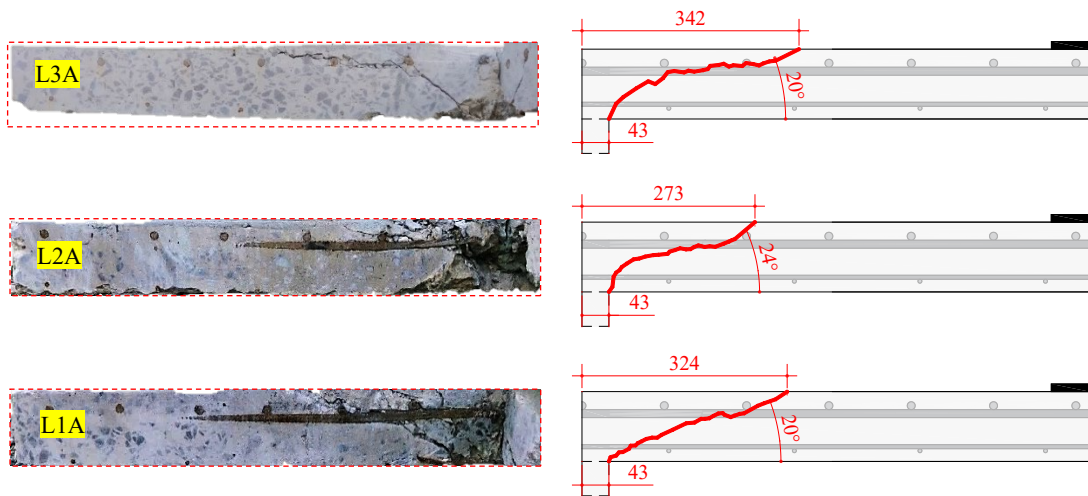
Corte das lajes da série A lado (y) paralelo ao $c_{máx}$ (mm)
